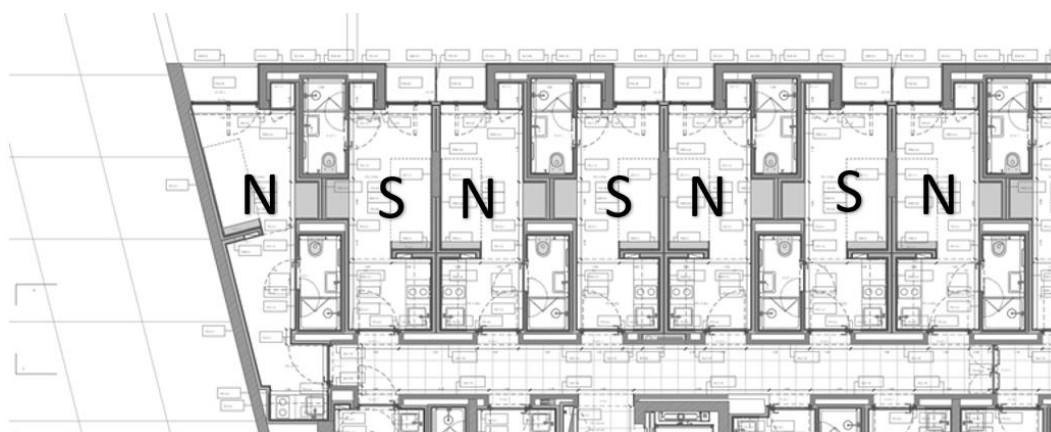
Identificação dos quartos (Adaptado de: Planta Piso Tipo – Anexo V)
